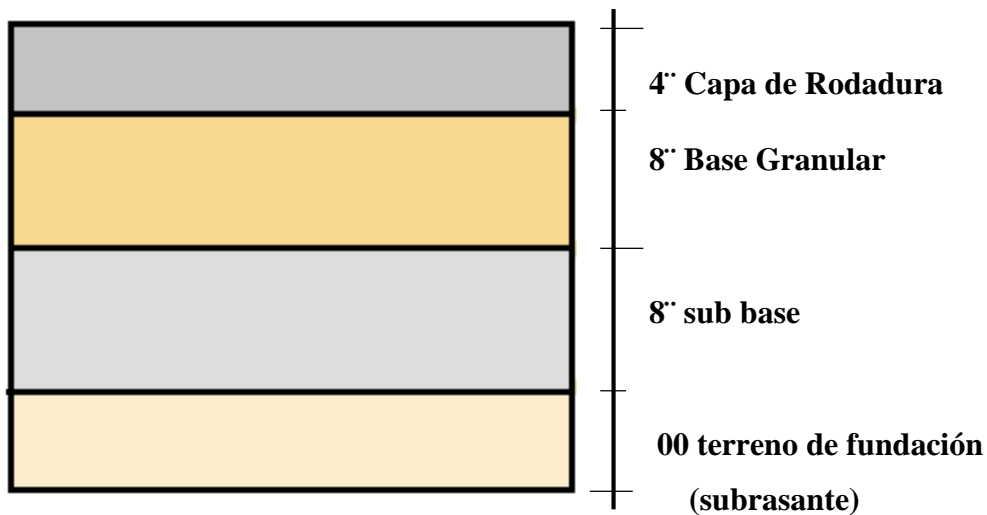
Estructura de Pavimento Propuesta para la Carretera Trujillo – Laredo.
